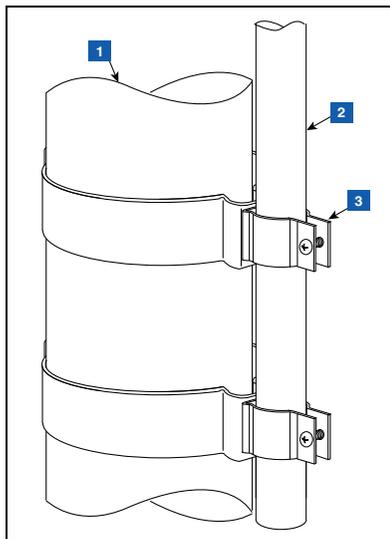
Fixation du conduit de 12,7 mm à la bride de 12,7 mm sur le tuyau ascendant
